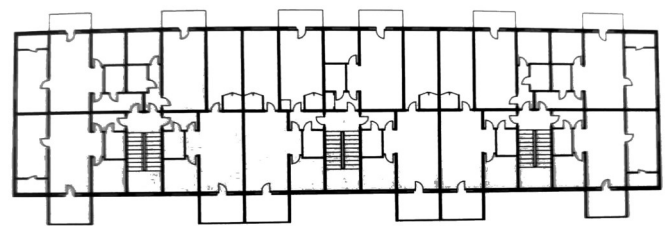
Blocco di appartamenti in tre sezioni a Taschkent (1967); le tre sezioni sono collegate da una parete comune.
